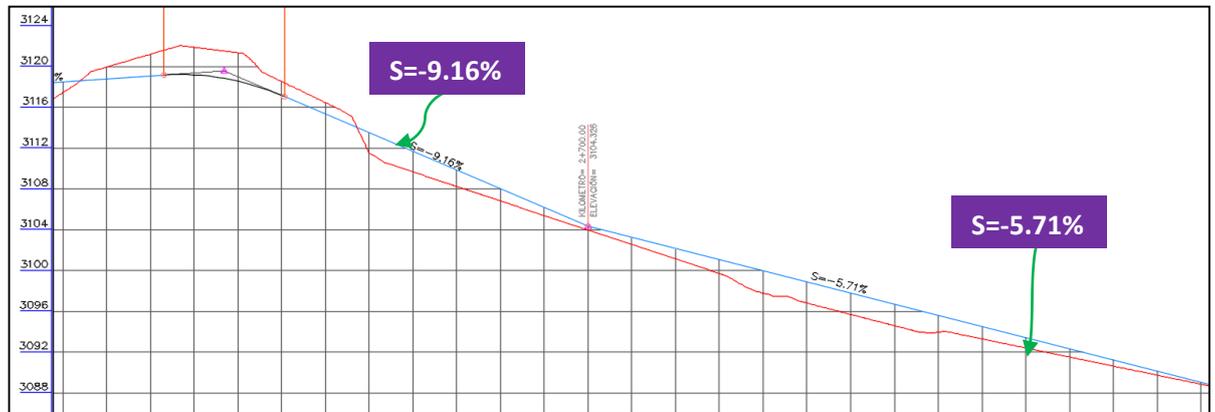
Pendientes del perfil longitudinal de la carretera
